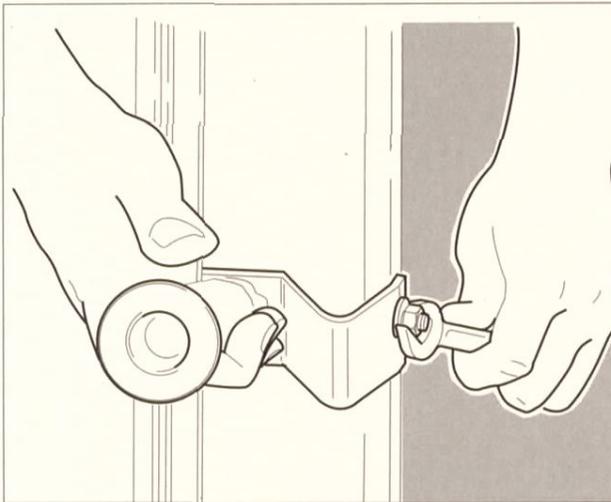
Tragegriffe liefern wir auf Wunsch. An beiden Seiten des Kollektors mit Befestigungsklemme - höheren Absatz zum Kollektor (siehe Lupe Bild 1.1) - festschrauben. Sicherem Halt überprüfen!
